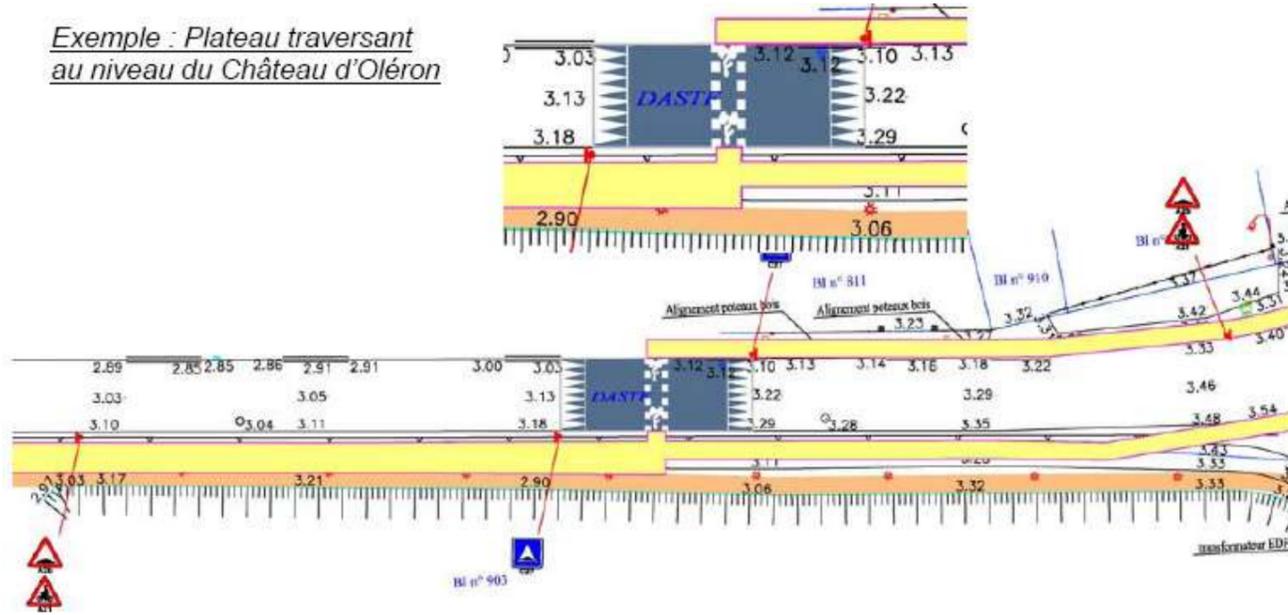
Plateau traversant au niveau du Château d'Oléron (Source : Etude paysagère PVIII)
